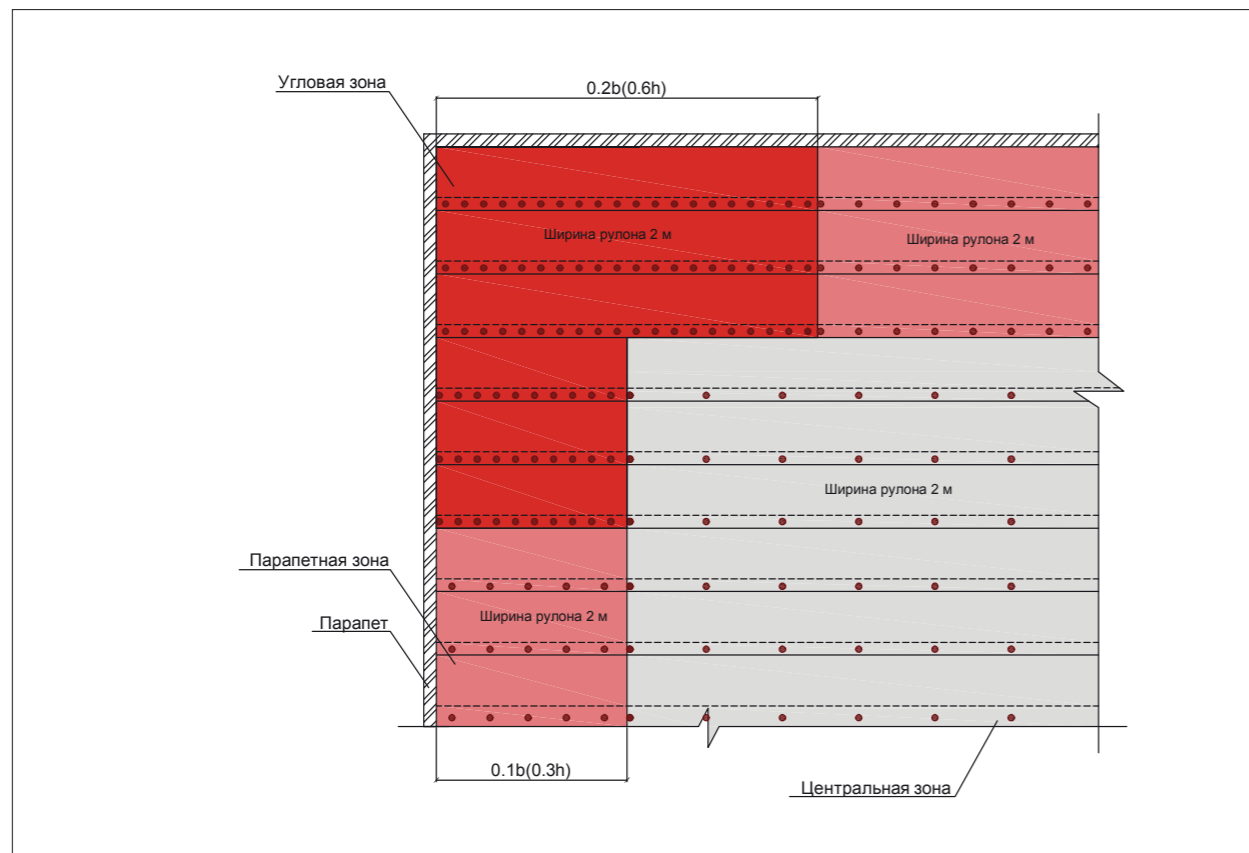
б Вариант раскладки и крепления полотнищ по бетонному основанию
